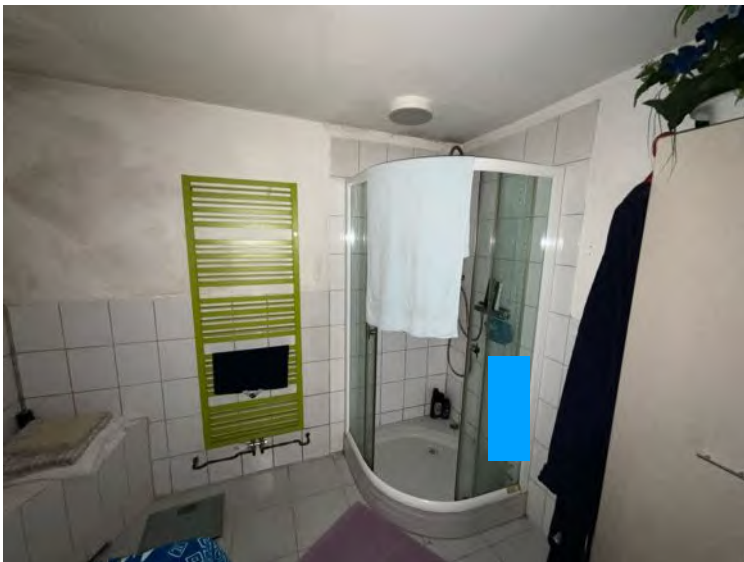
Bad/WC (EG) mit Feuchte- und Substanzschäden im Wandbereich
